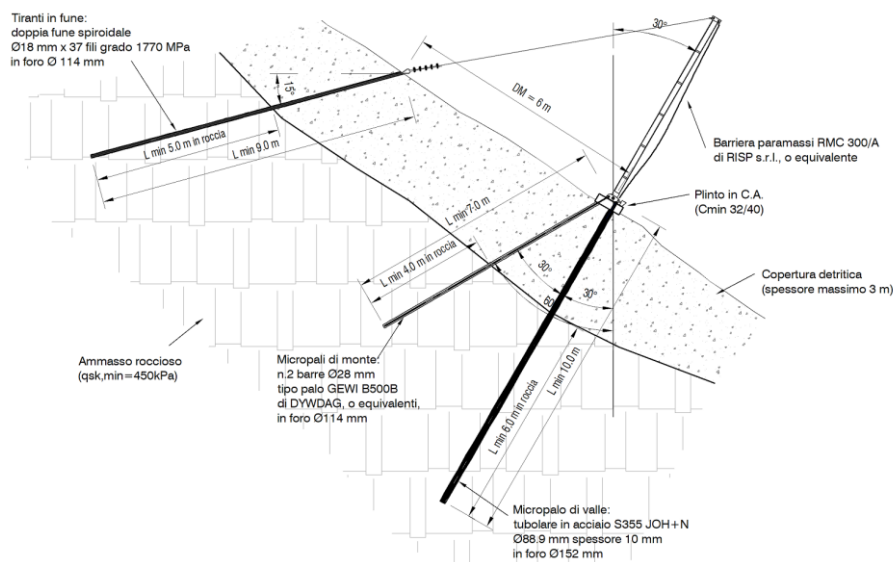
Sezione tipologica delle strutture di fondazione della barriera paramassi.
